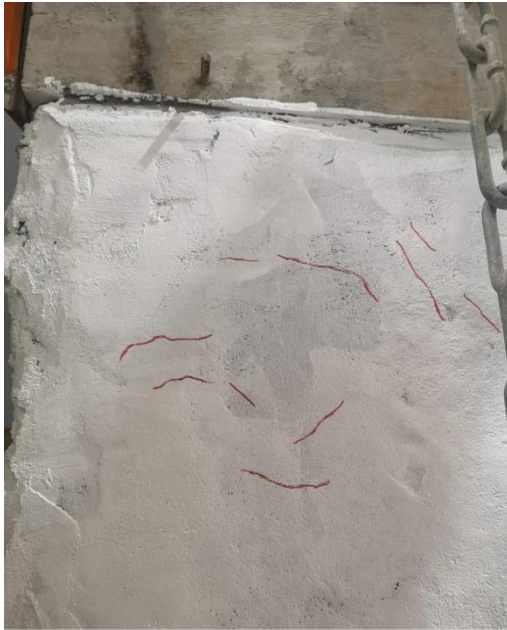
Grietas en zona de estuco en secuencia de 12 (mm) (Fuente: Elaboración propia).
